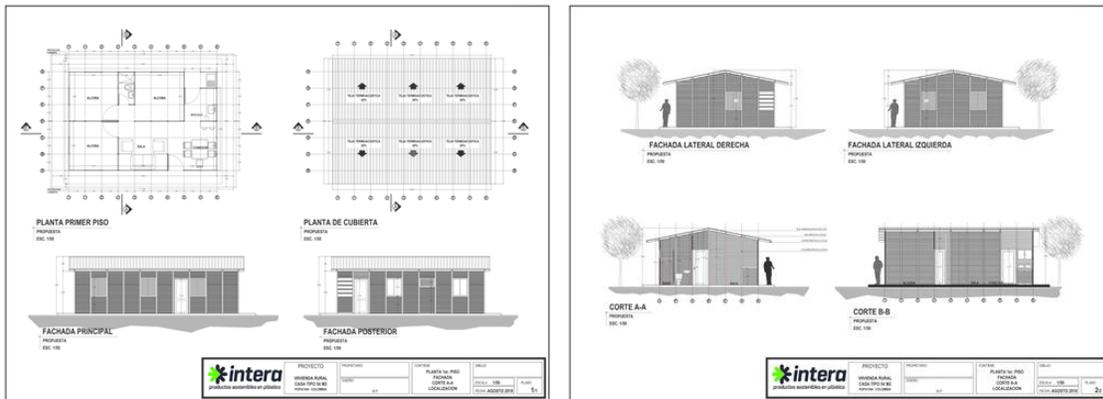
Planta Distribución Vivienda Rural 54 m<sup>2</sup> Sin Corredor. Fuente: Elaboración propia.
